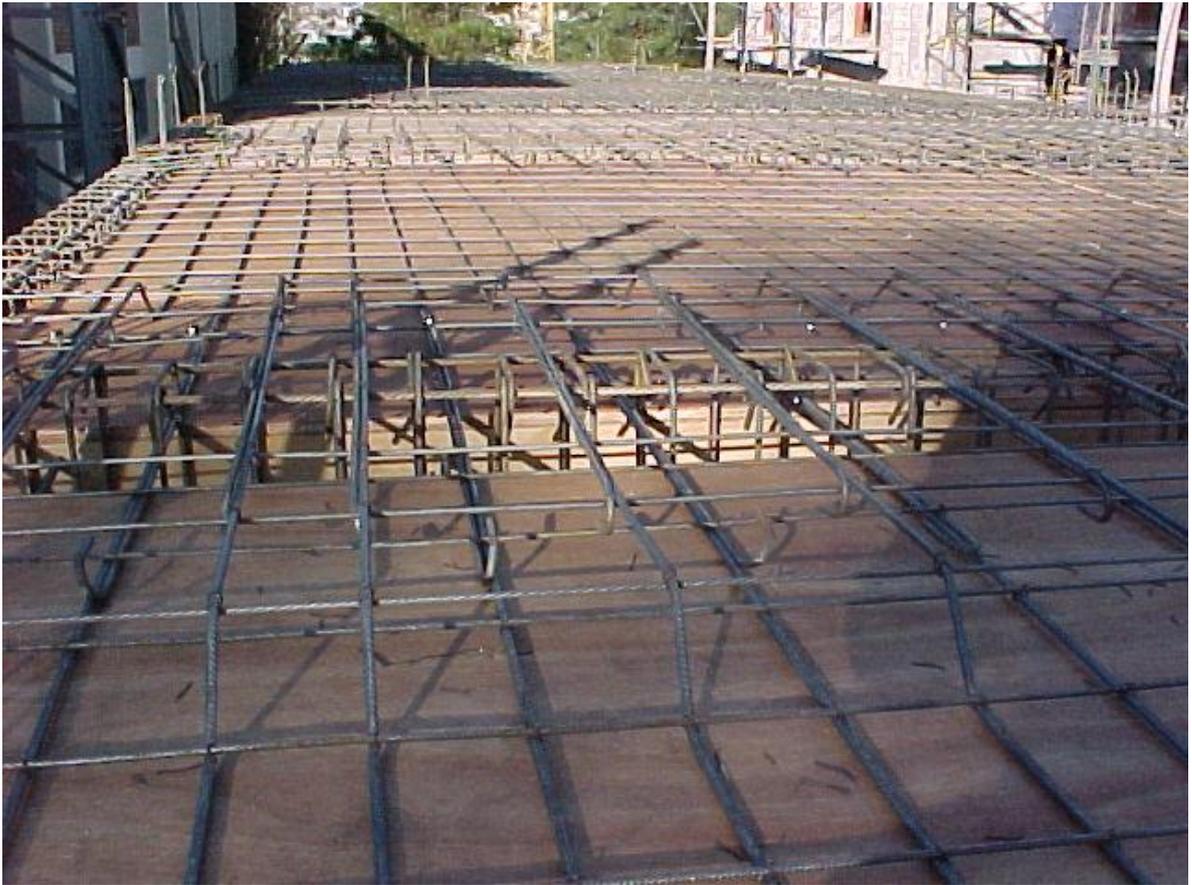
Encofrado de losa maciza de H°A°. Colocación de armadura de losa
